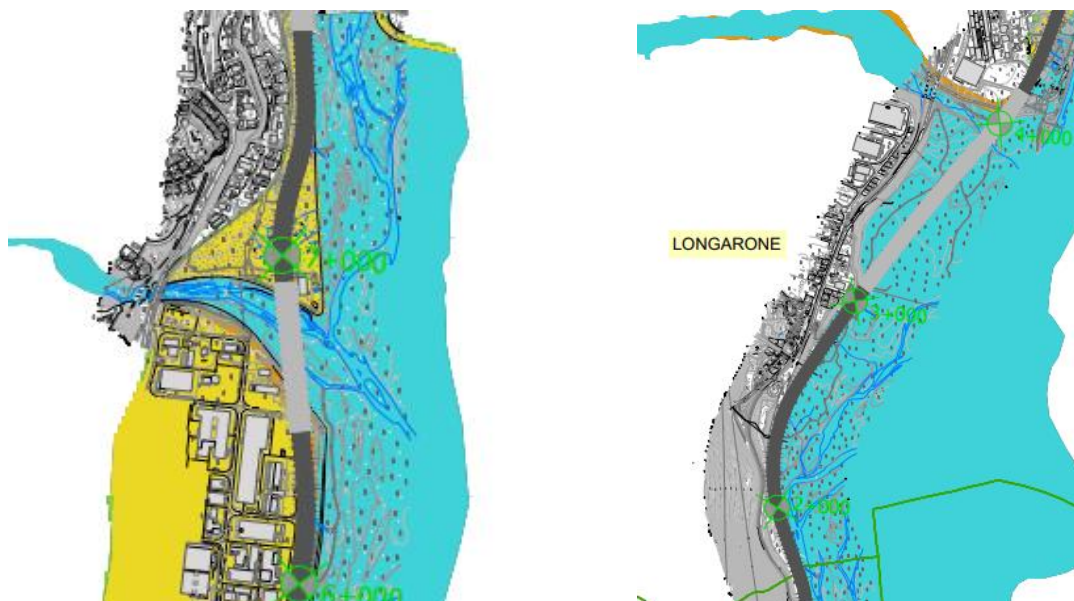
Stralcio Planimetria delle aree di pericolosità idraulica del PGRA
